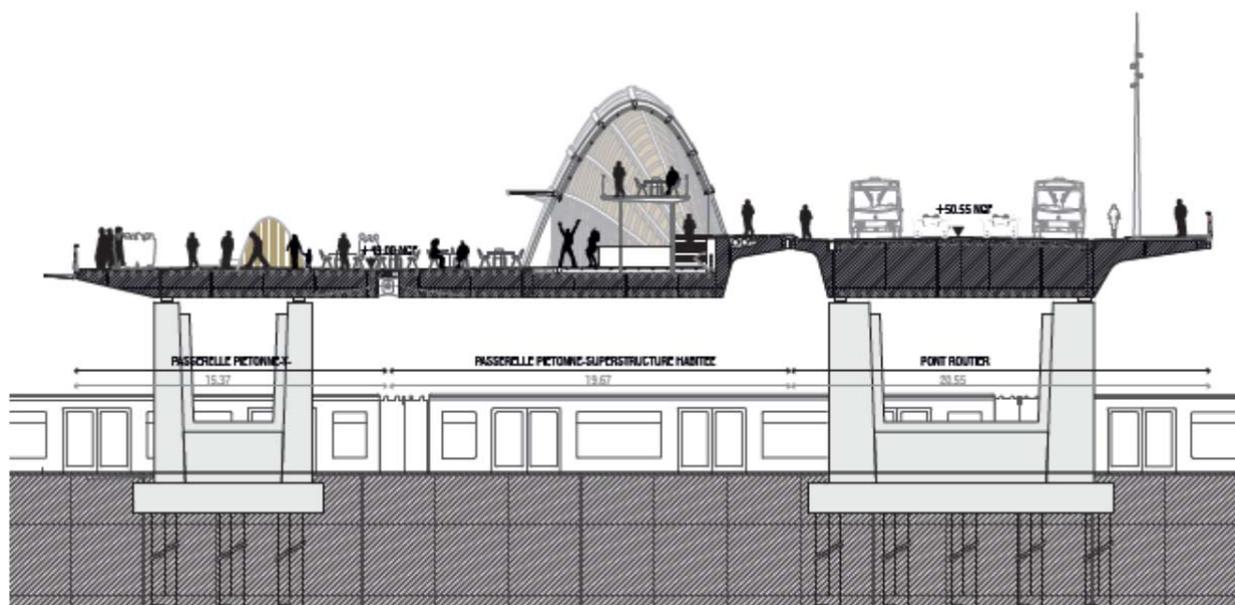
Coupe de la passerelle et du franchissement routier (source : dossier)
